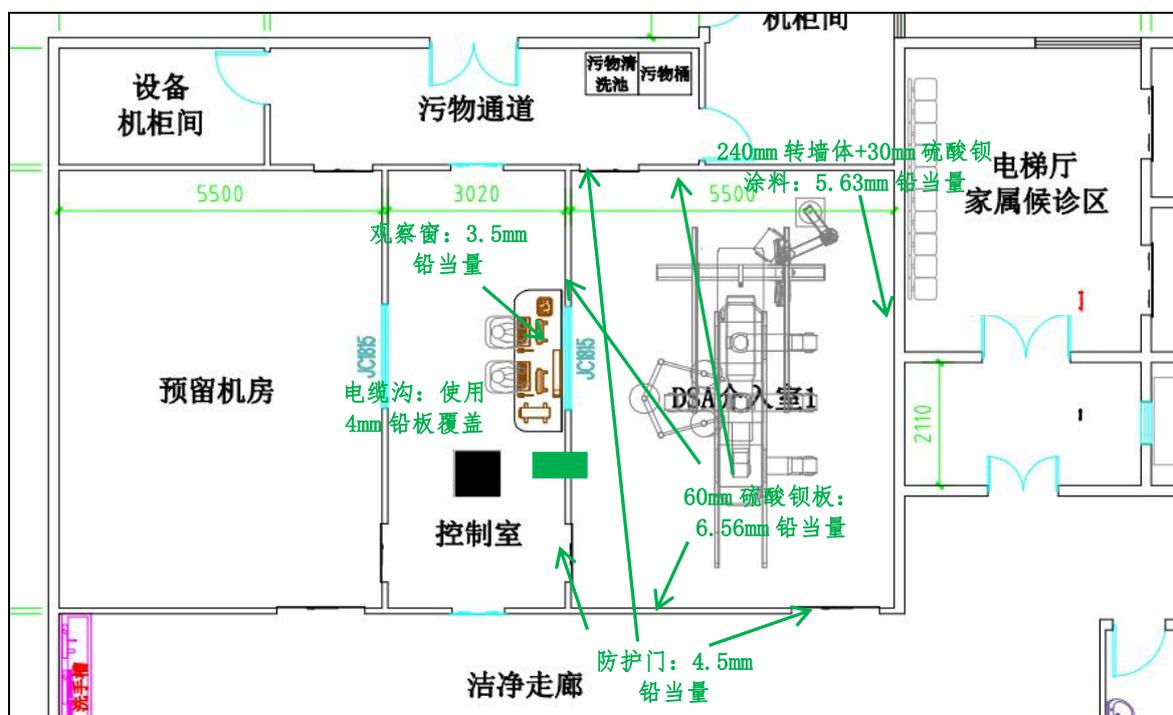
本项目 DSA 介入室屏蔽防护设计平面图
